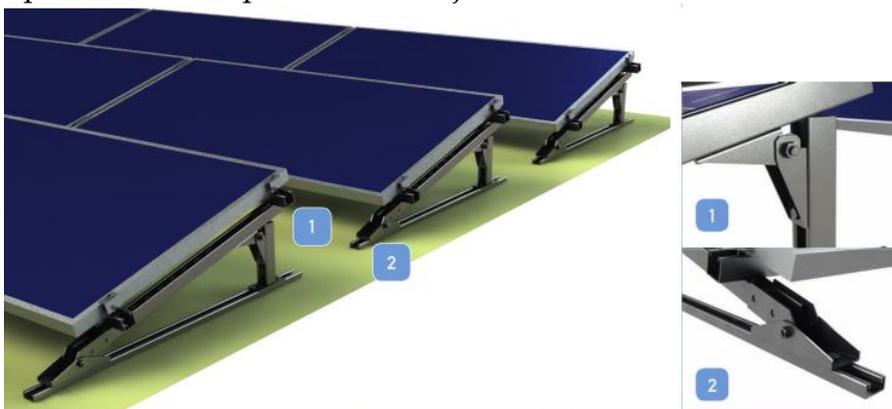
Estructura con una sola placa instalada en cubierta plana.
